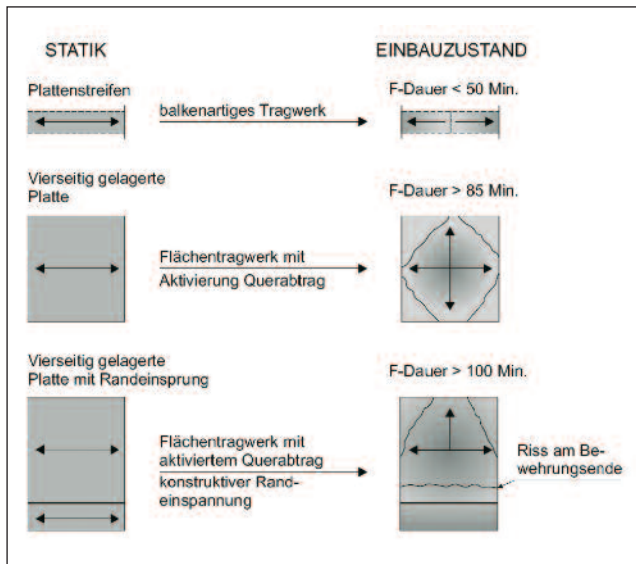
Statik/Einbauzustand mit Rissbildung von Stahlbetondecken ($u \approx 20 \text{ mm}$)
